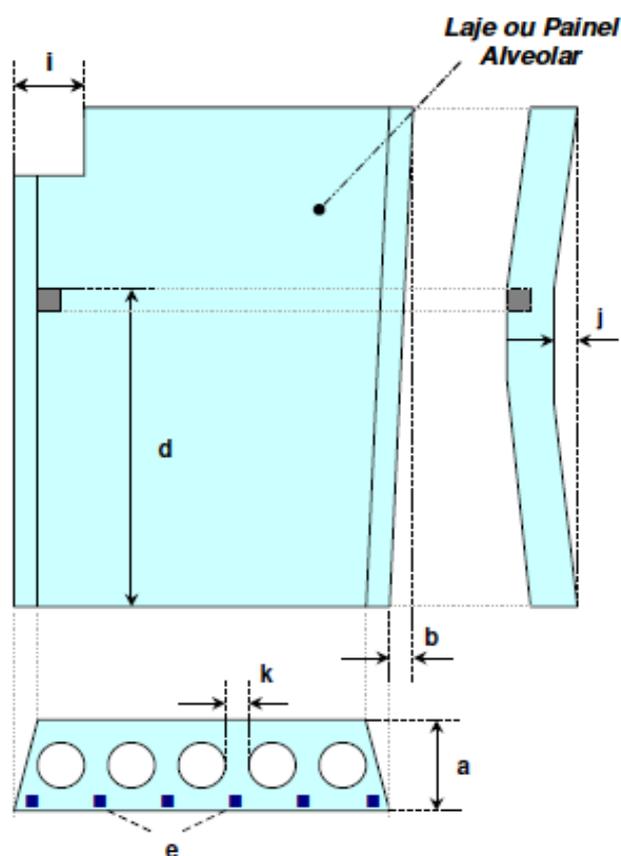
Desenho ilustrativo das tolerâncias de fabricação de lajes alveolares
